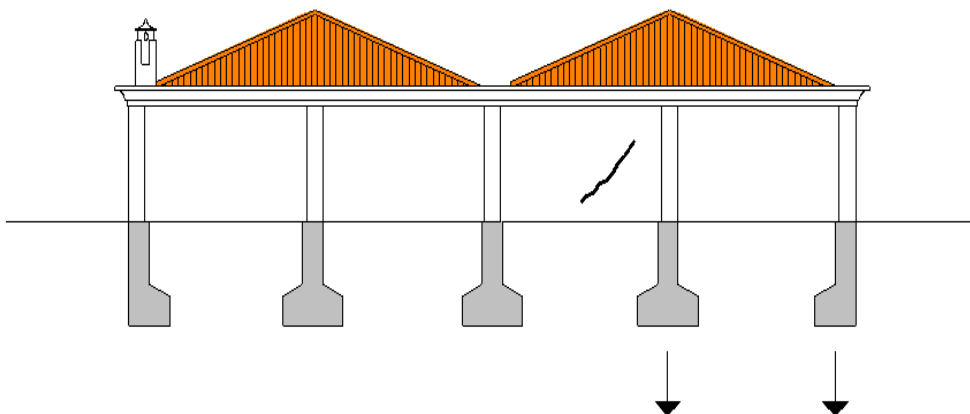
Família de fissuras originadas pelo assentamento de parte da estrutura (Modificado, Ortiz, 1983).
